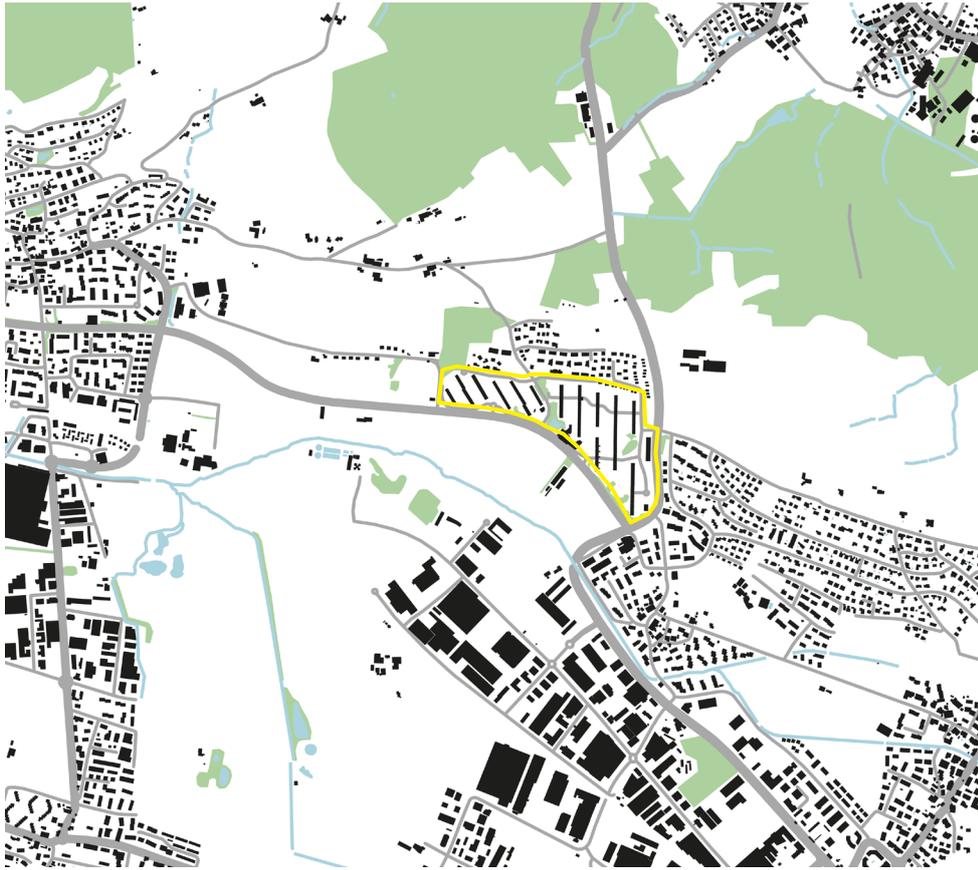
Siedlung Sonnhalde Regensdorf / Lageplan mit Gebiet
